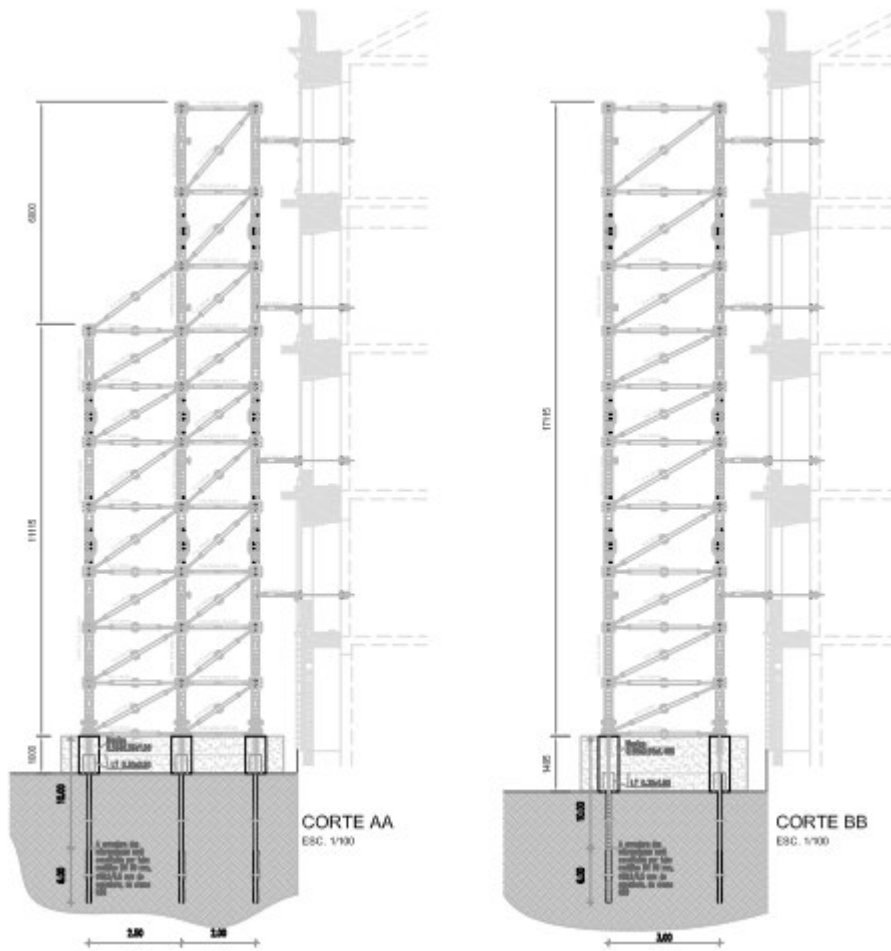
Corte EMCF. [Fonte: Projeto de fundações]
